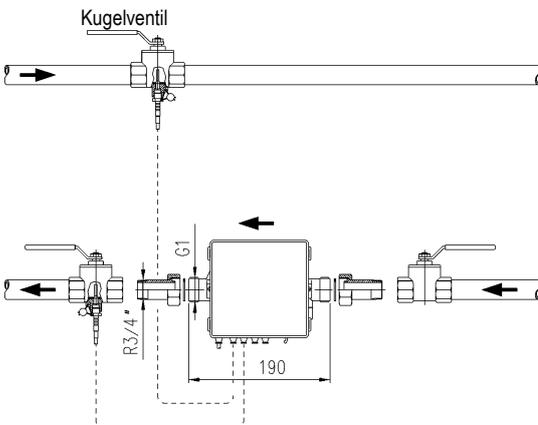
Einbindung mit Kugelventil (empfohlen bis einschließlich DN25)
